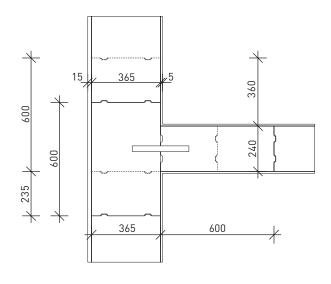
Соединение наружной стены с внутренней на стык с использованием соединителя LP30
